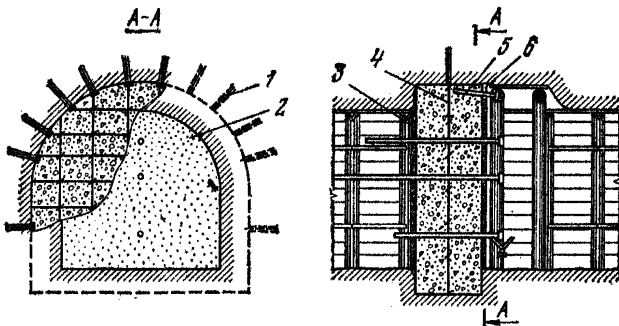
Бетонная динамически устойчивая перемычка:
